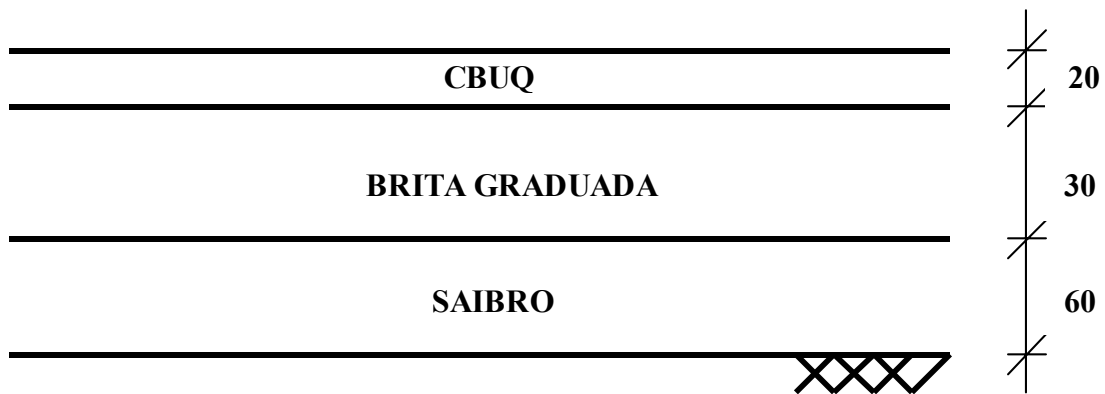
Pavimento do km 105 (faixa externa/pista sul)
